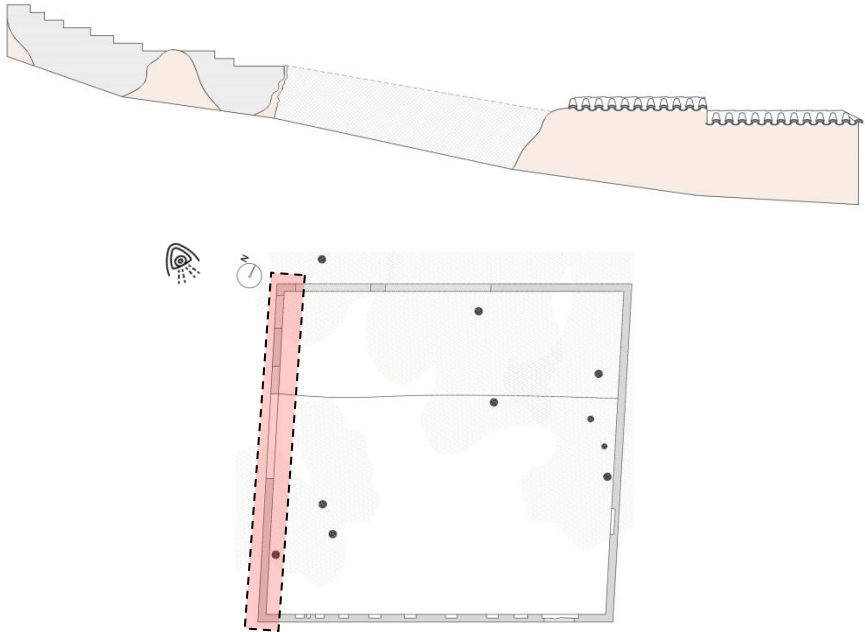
Esquema de planta-alzado fachada Oeste estado actual. Fuente propia.
